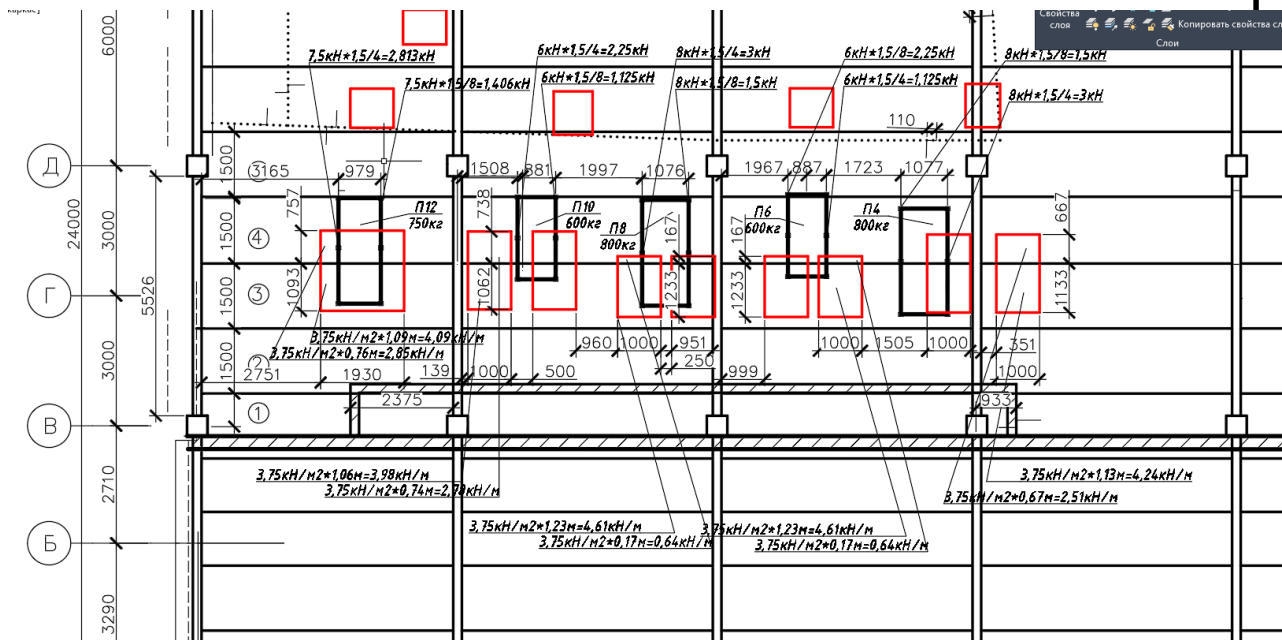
Схема приложения нагрузок от существующего оборудования ОВ и фундаментов Ф в осях 9-13
